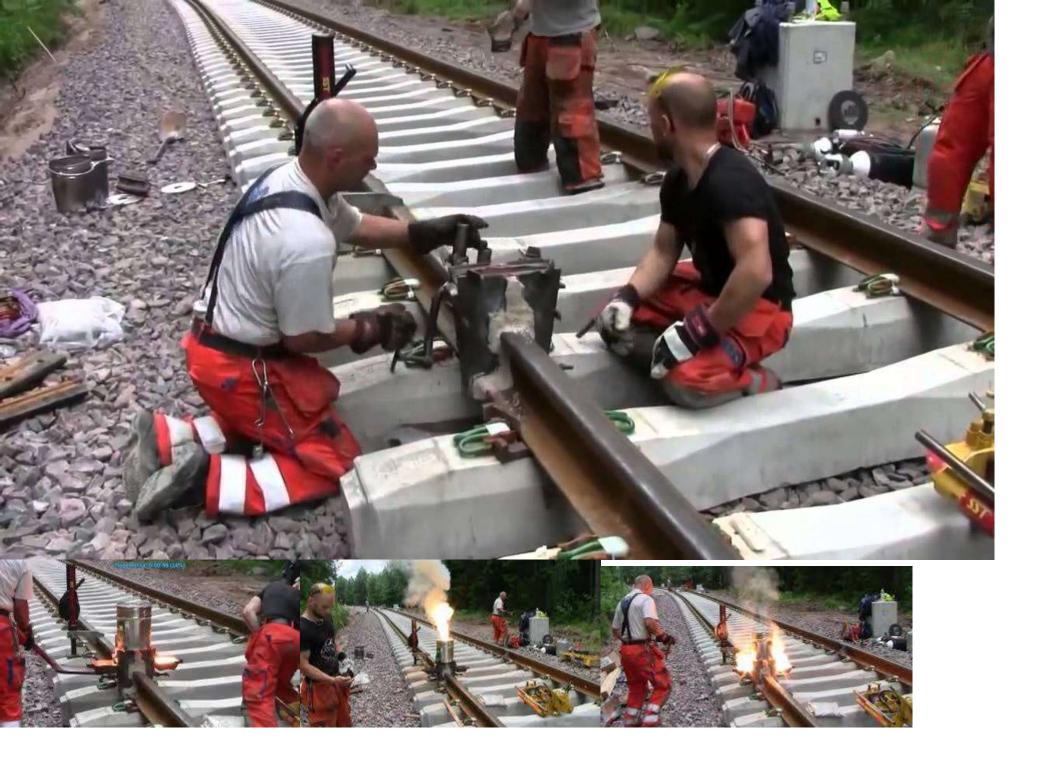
Сухая форма для термитной сварки рельсов.
